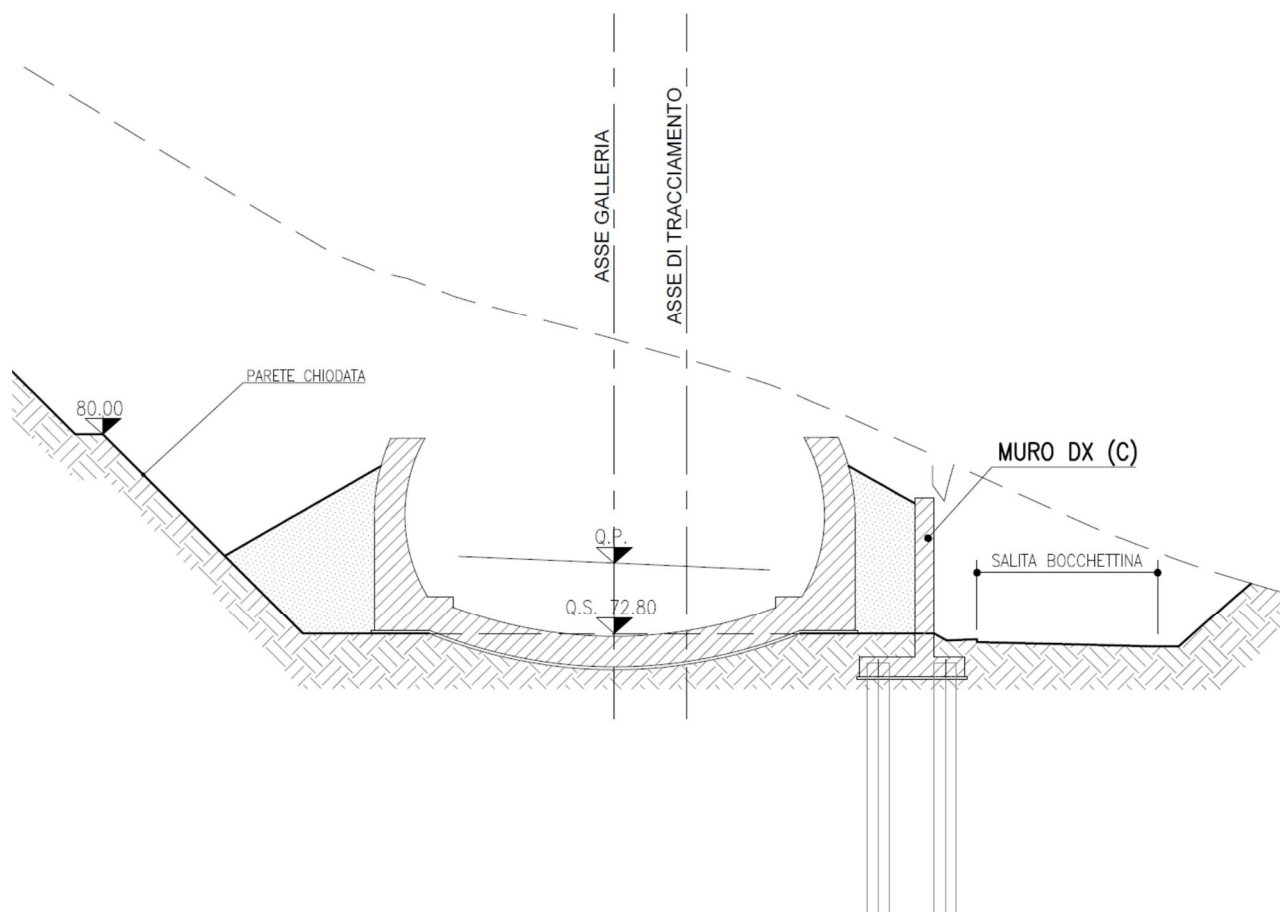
Imbocco Forte Diamante - Muro DX (C)
